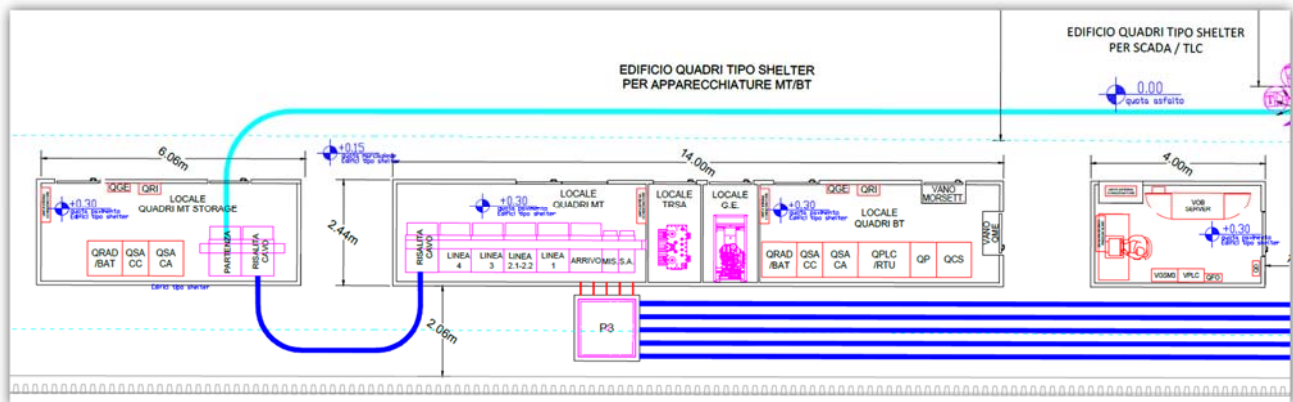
Layout dell'aggregato di Locali Tecnici in sottostazione Produttore.
